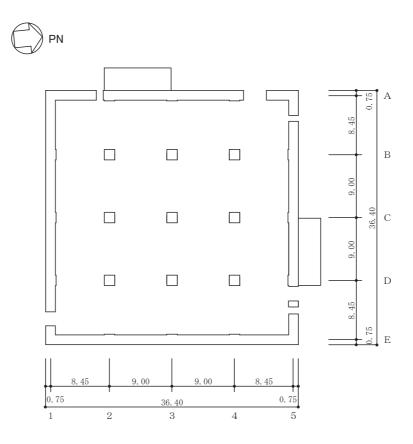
(1) 緊急時対策建屋の概略平面図 (0.P.*51.5m)
